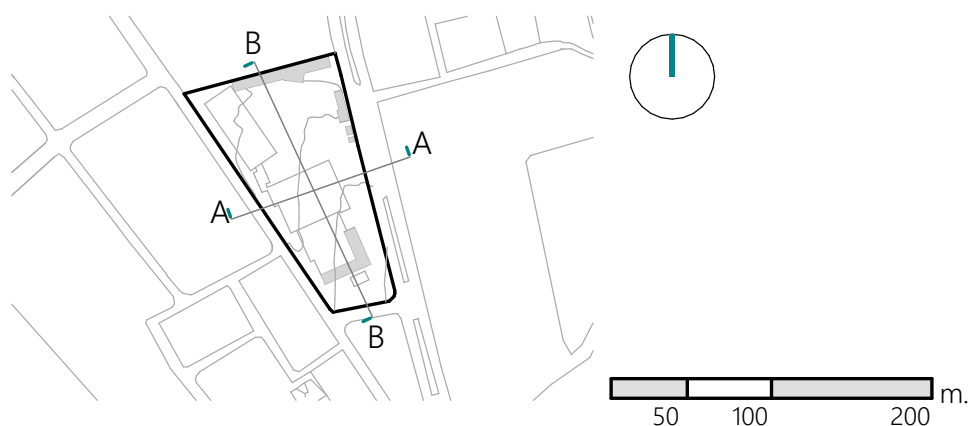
Diagrama de planta donde se especifica las secciones A-A, B-B. Elaboración: Autor.
